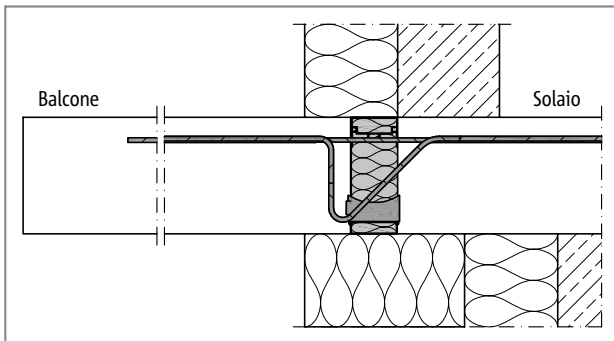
Schöck Isokorb® T tipo KL, raccordo indiretto a solaio con cappotto
